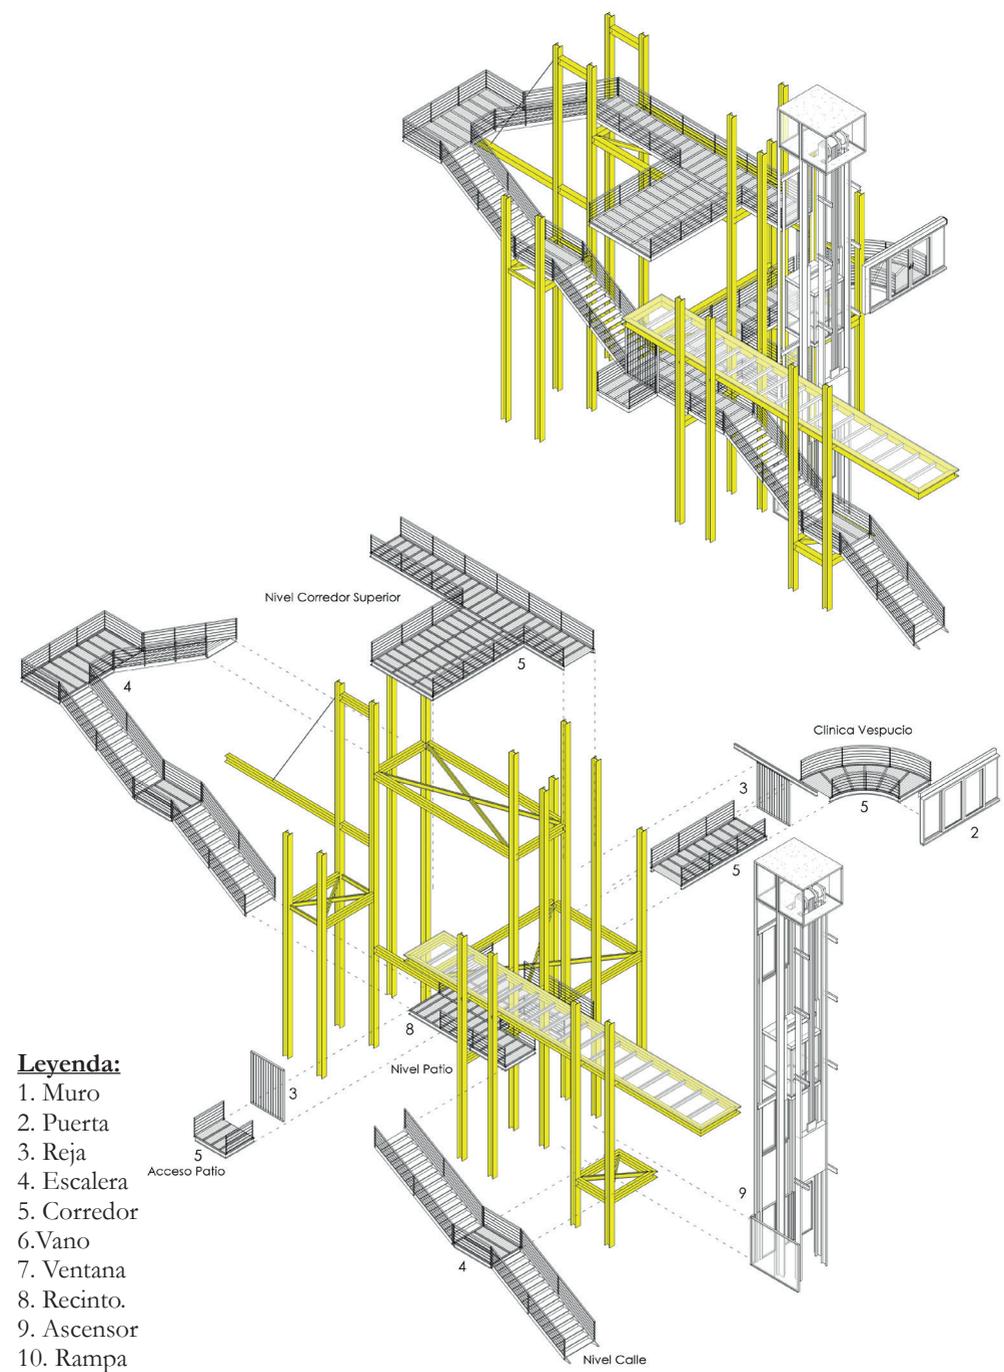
Plano ubicación mediador traspaso entre exteriores divergentes C. (2021). Planimetría. Elaboración propia.
